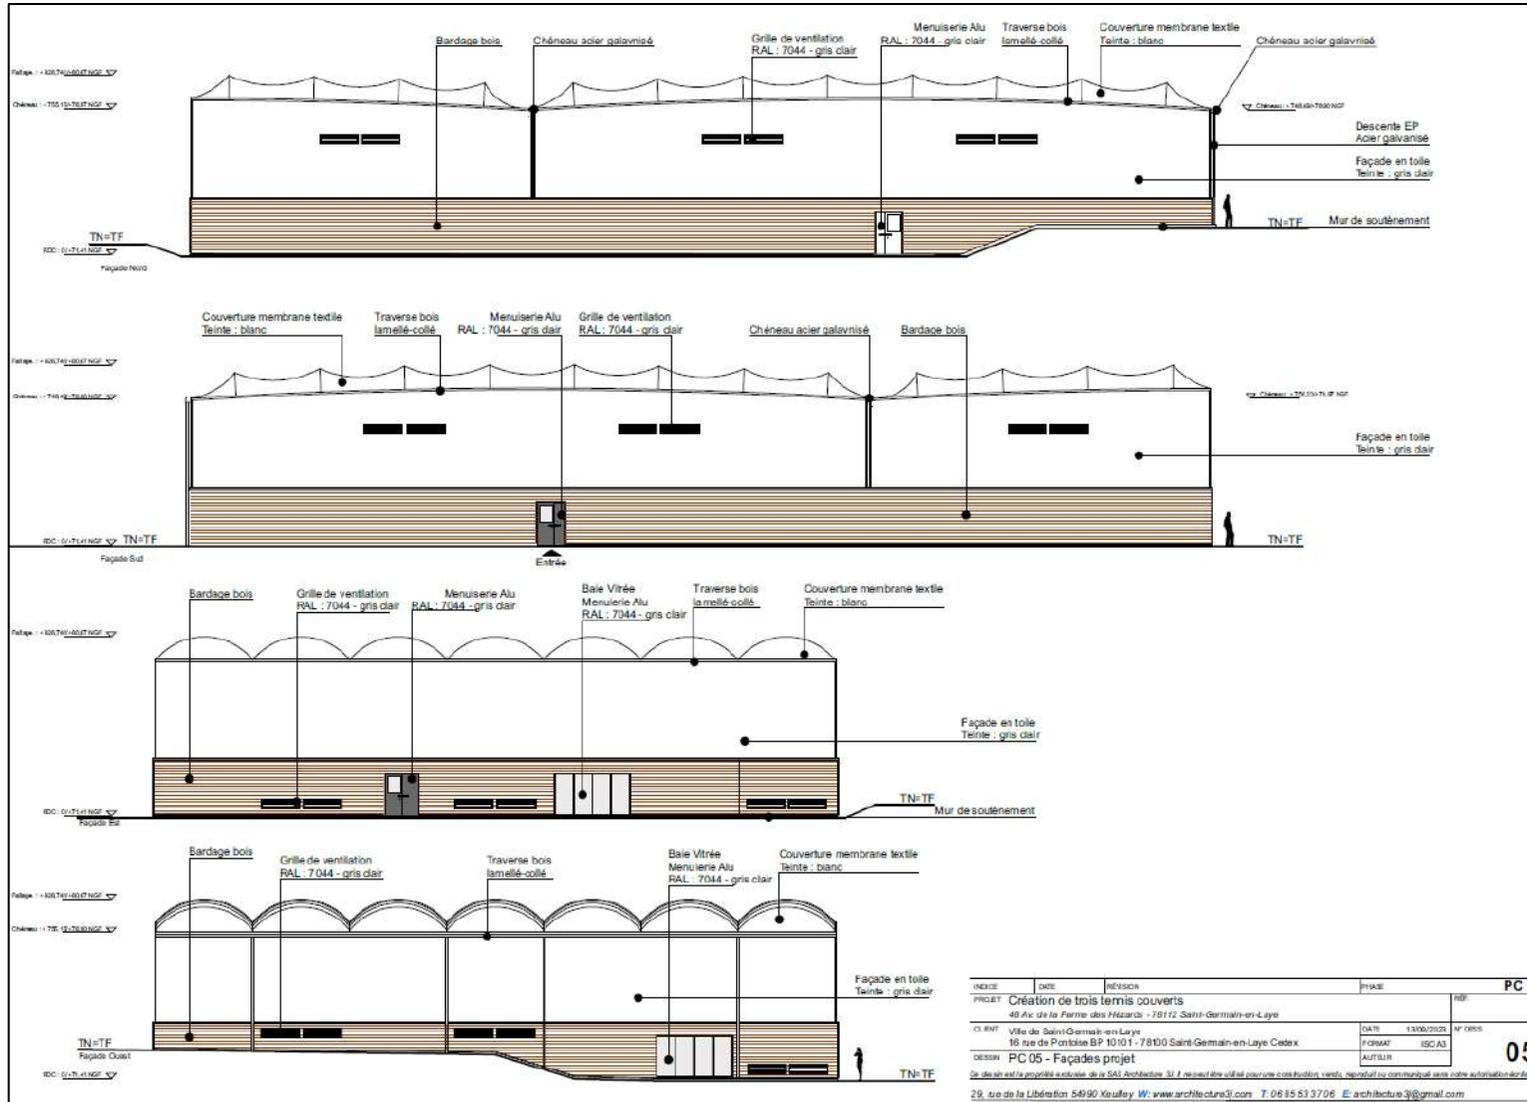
Plan en coupe des façades projetées - zone A, SAS Architecture 3J
